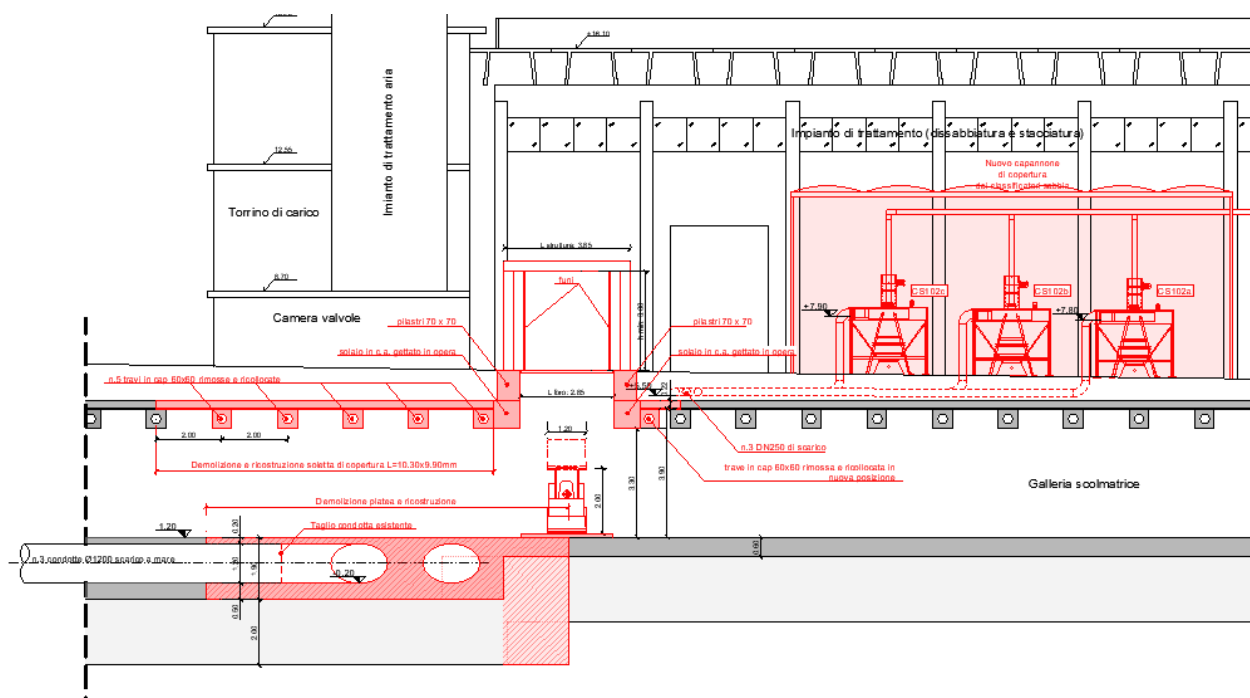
Interventi sulla galleria di Seiano: Sezione
